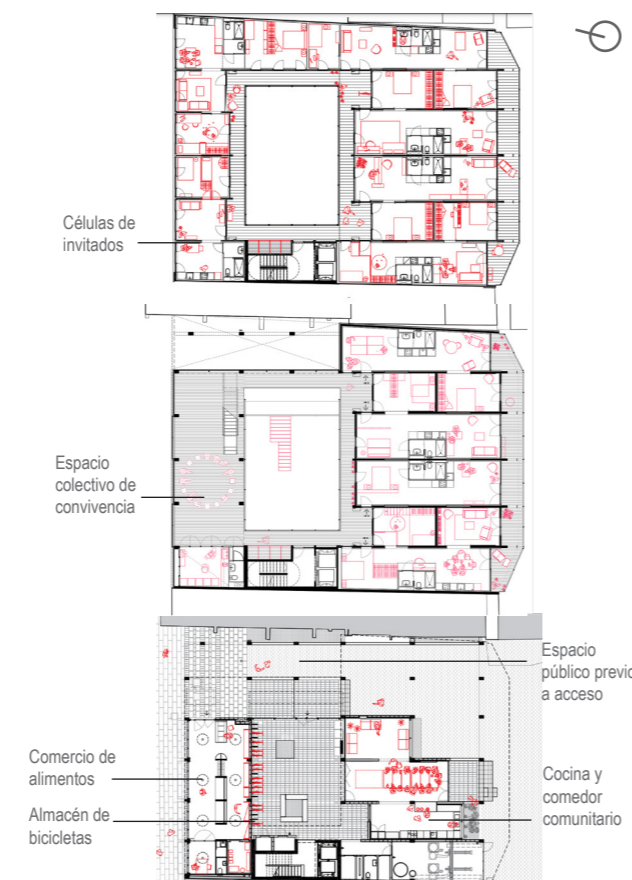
Planta primer piso. Imagen con intervención propia.
